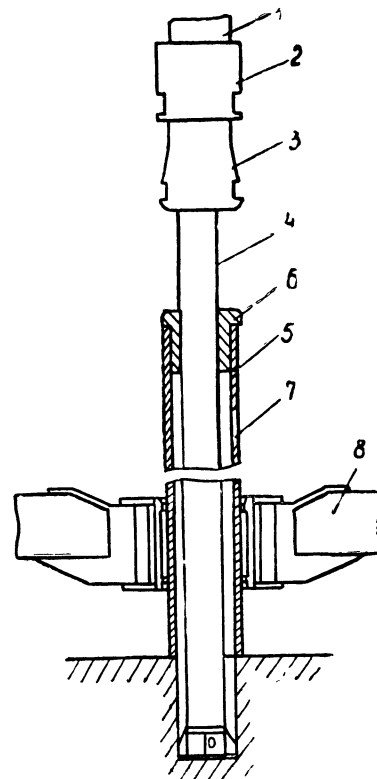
Общий вид устройства для погружения винипластовых труб:
